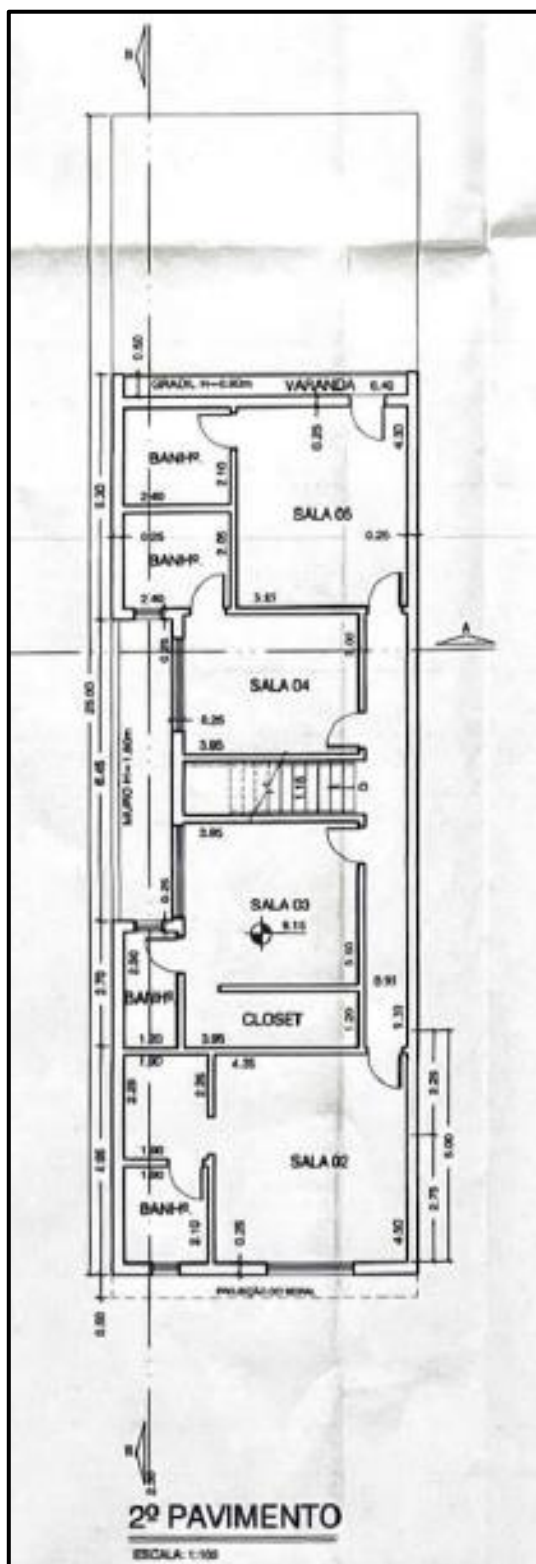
2º pavimento (2º andar) – Sala 02
